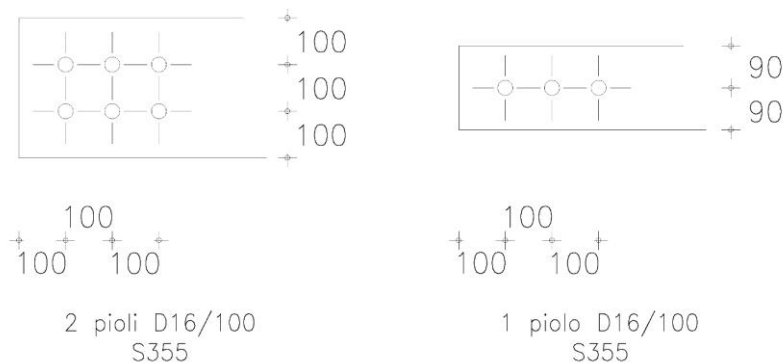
Distribuzione dei pioli alle estremità delle travi principali e delle travi secondarie
